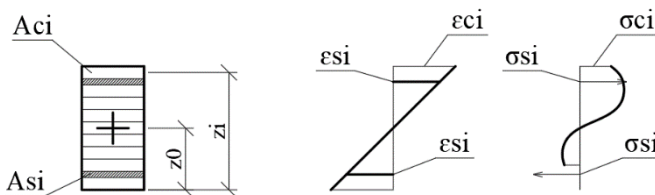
Расчетное поперечное сечение и распределение деформаций и напряжений изгибаемого железобетонного элемента
